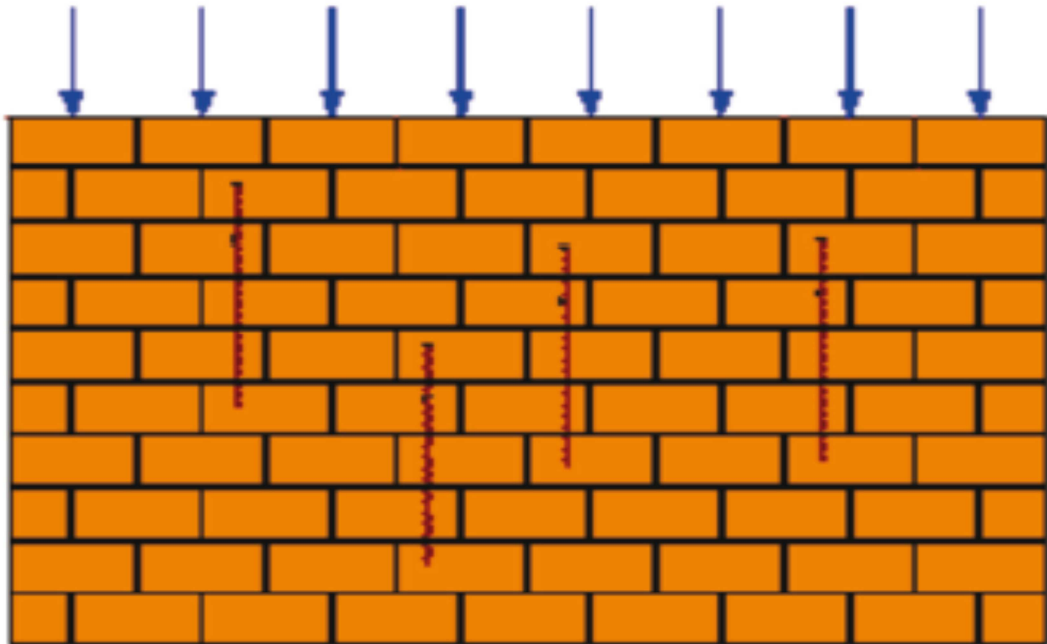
Fissuras verticais ao longo da parede.
